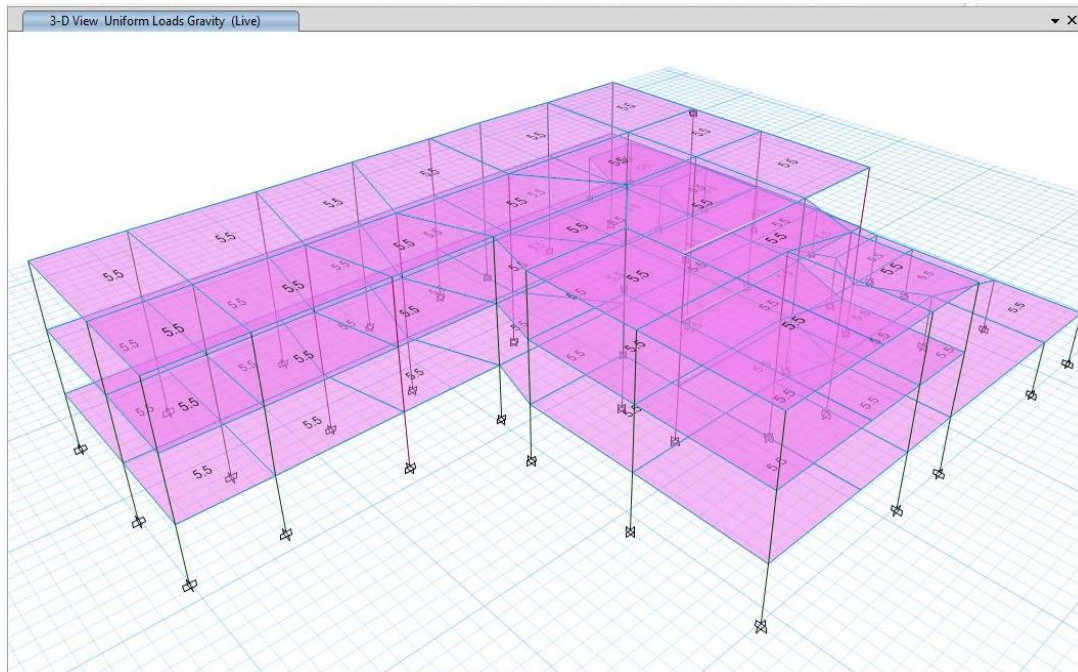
Carga Viva y Viva de Cubierta Distribuida ( $KN/m^2 - KN/m$ )
